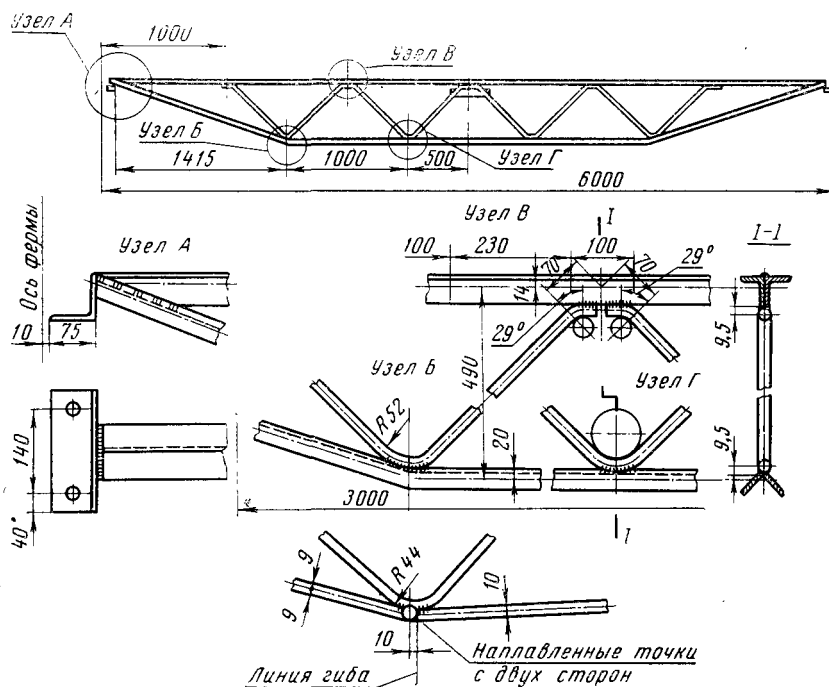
Конструкция сварной легкой фермы с прутковыми раскосами
